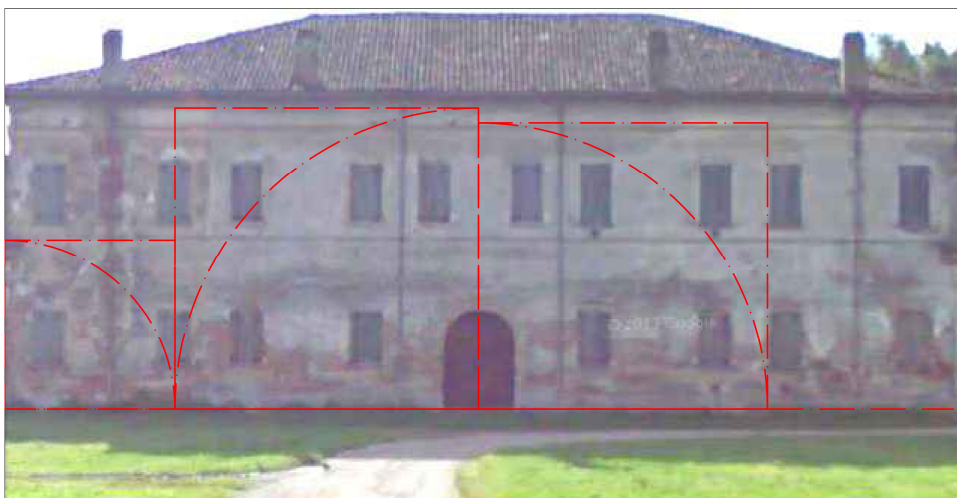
Tracciati regolatori prospetto principale casa padronale Corte Rozza
